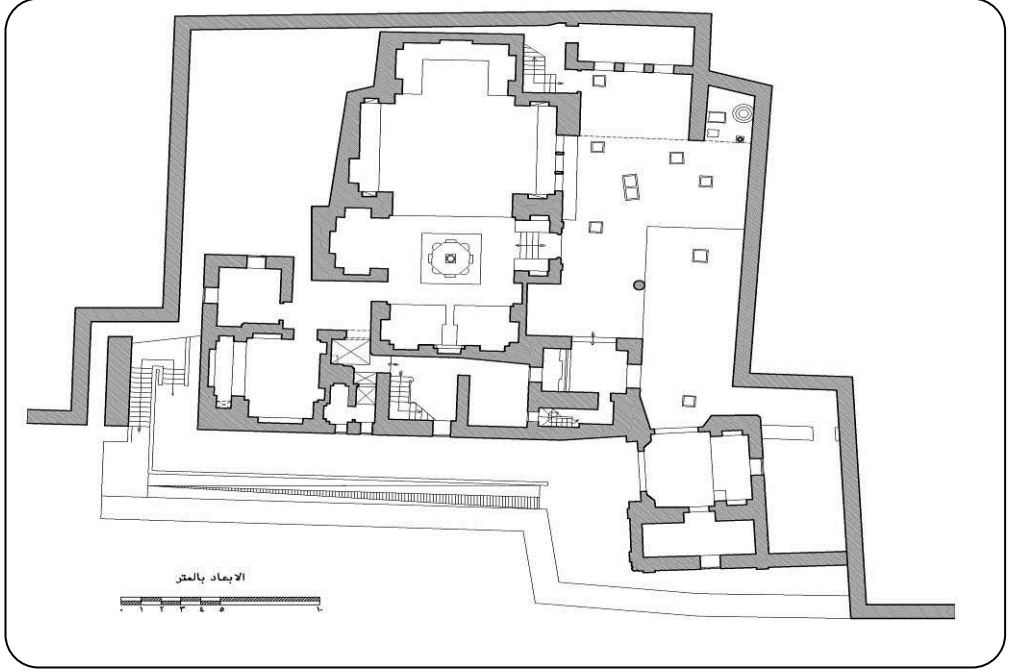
المسقط الأفقي للدور الأول لمنزل الست وسيلة ١٠٧٤هـ /
